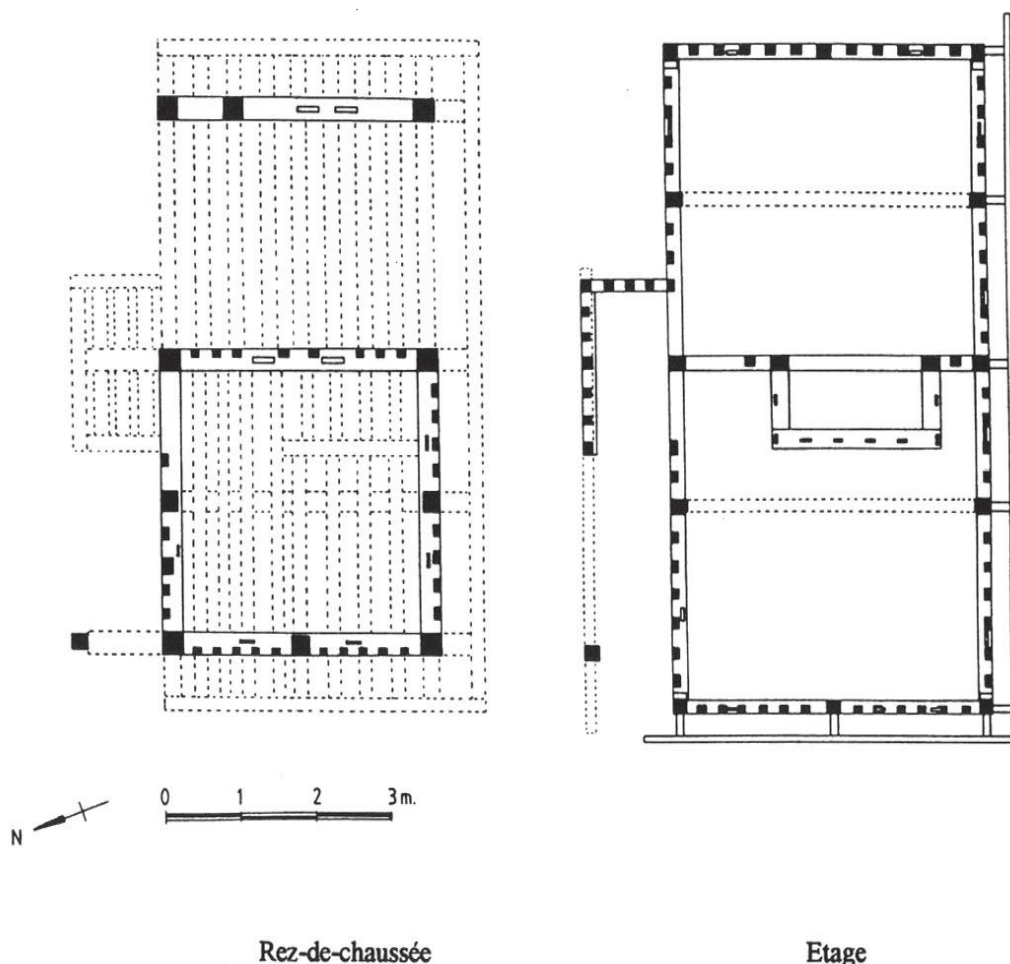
Plans restitués du rez-de-chaussée et de l'étage.
